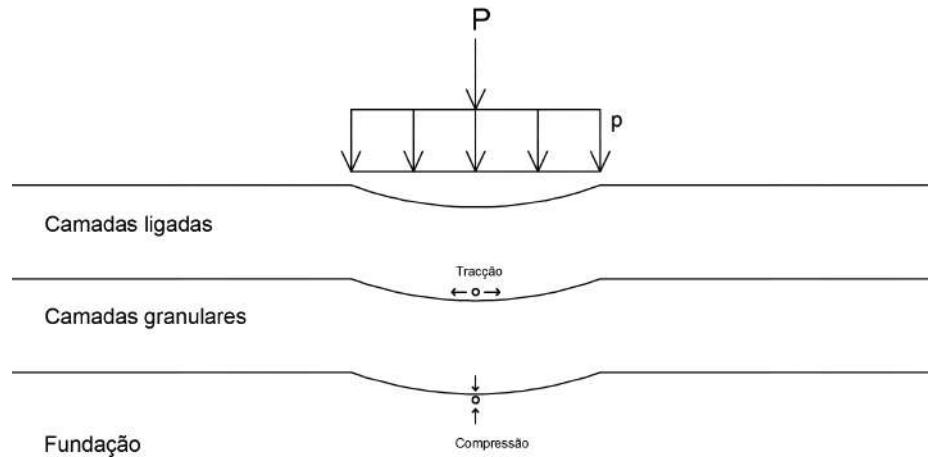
Estrutura tipo de um pavimento rodoviário e ações (adaptado de (Branco, Ferreira e Picado-Santos, 2011))
